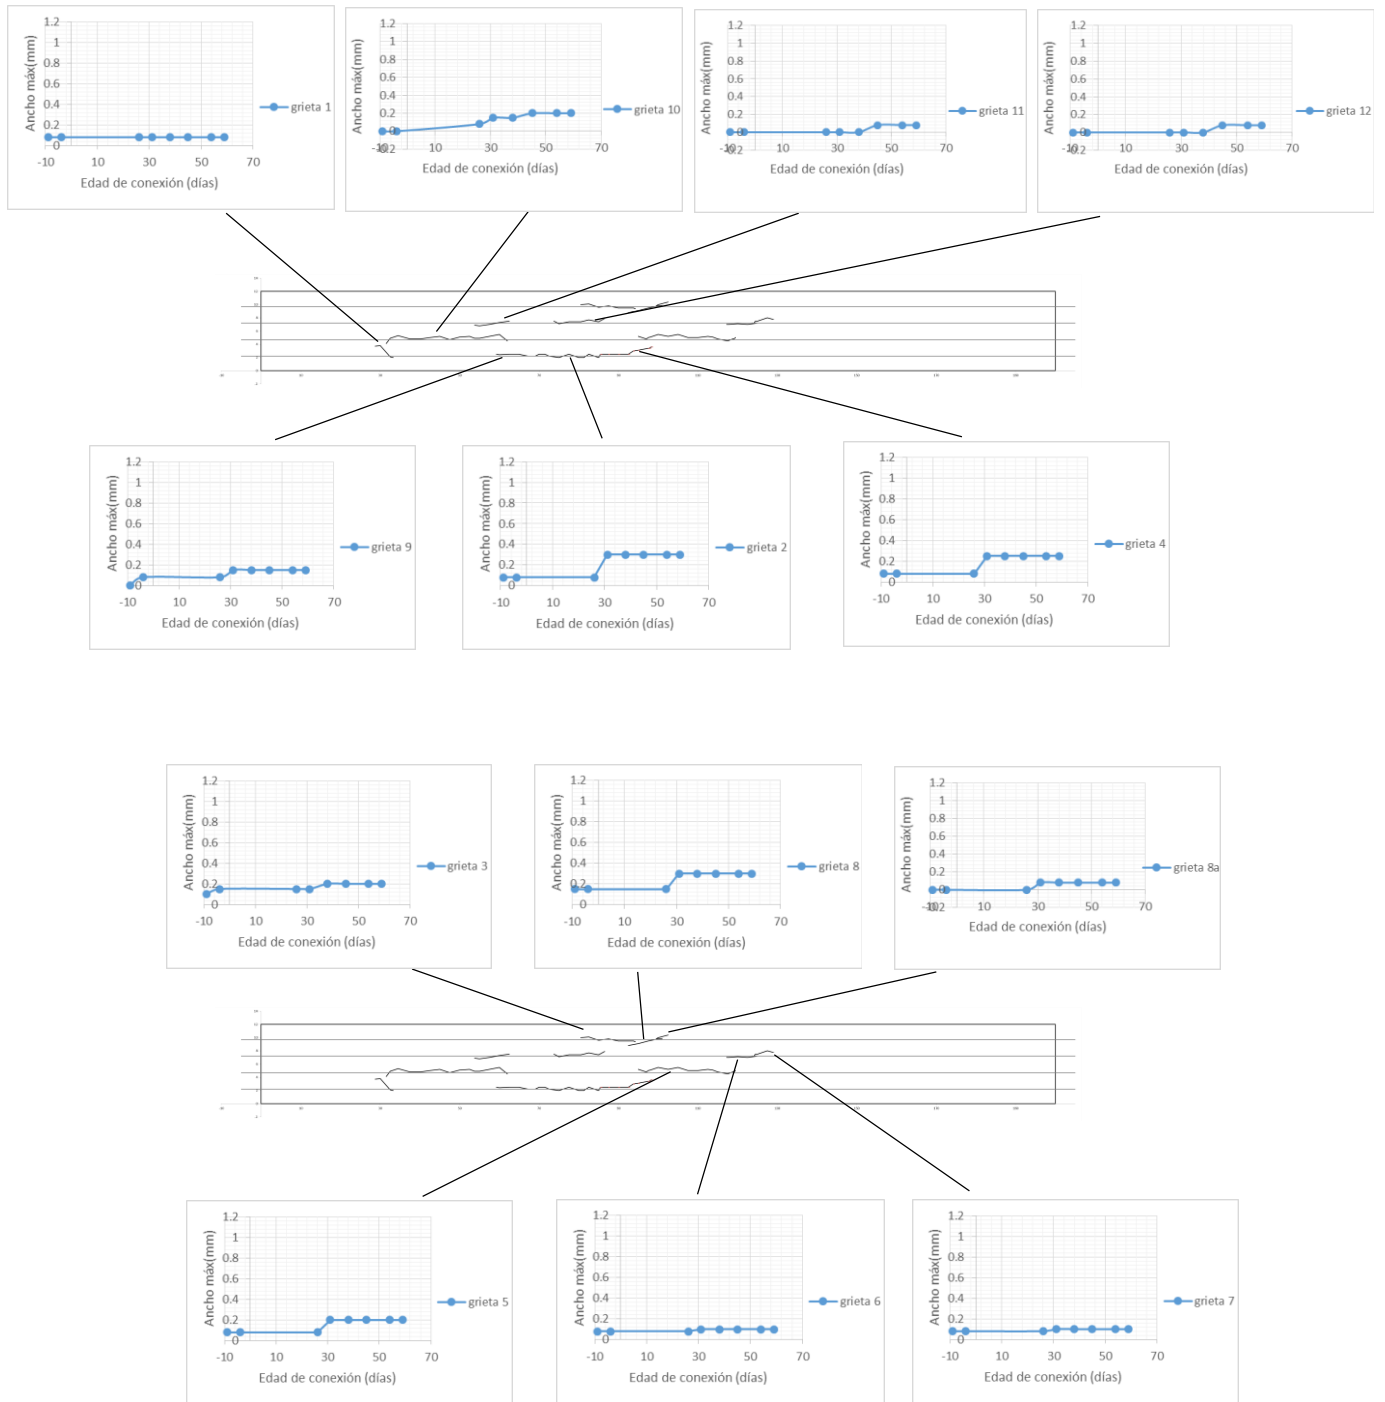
Localización y ancho máximo de grieta viga VCPC3.
